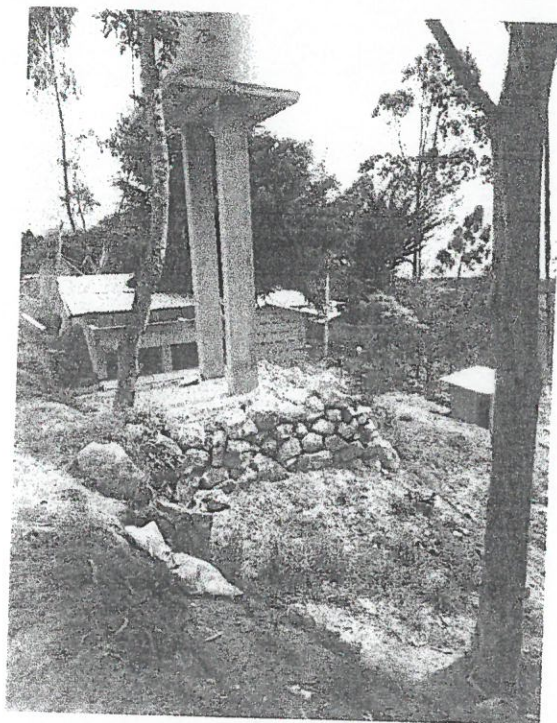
Estructura que soporta el tanque elevado afectado por la humedad.
